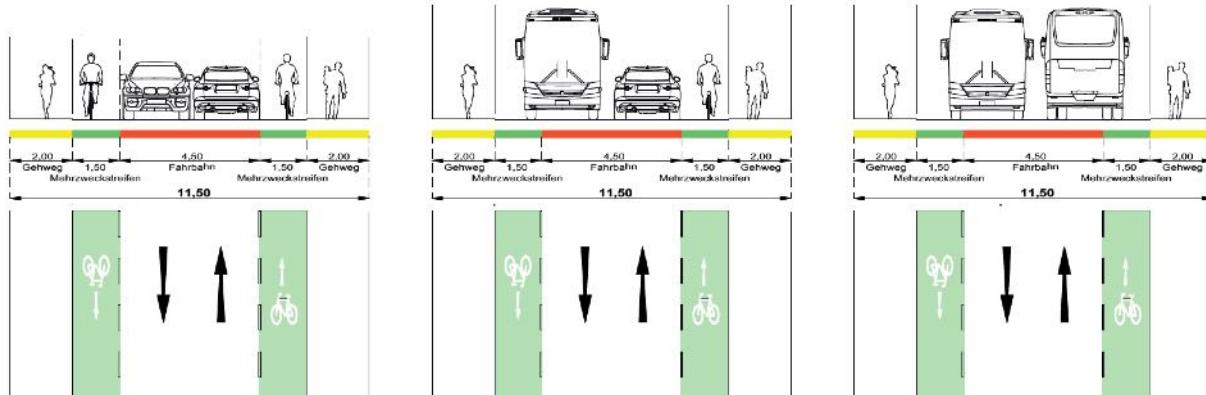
Querschnitt Planfall 4, [Quelle: PLANUM]
